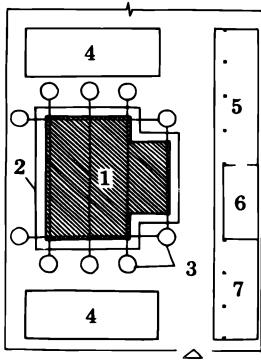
Примерная схема организации строительной площадки (стройгептлан)
